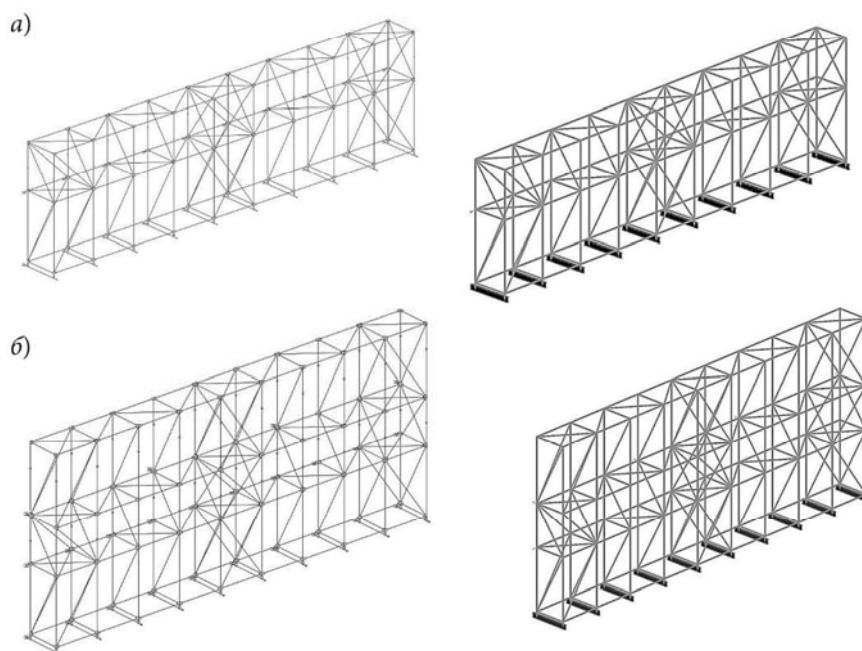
Расчетная схема защитного экрана: а — на I этапе производства строительно-монтажных работ; б — на II этапе производства строительно-монтажных работ
